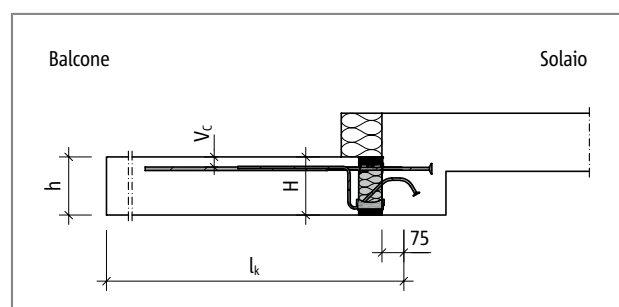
Schöck Isokorb® T tipo KL-U: schema statico
